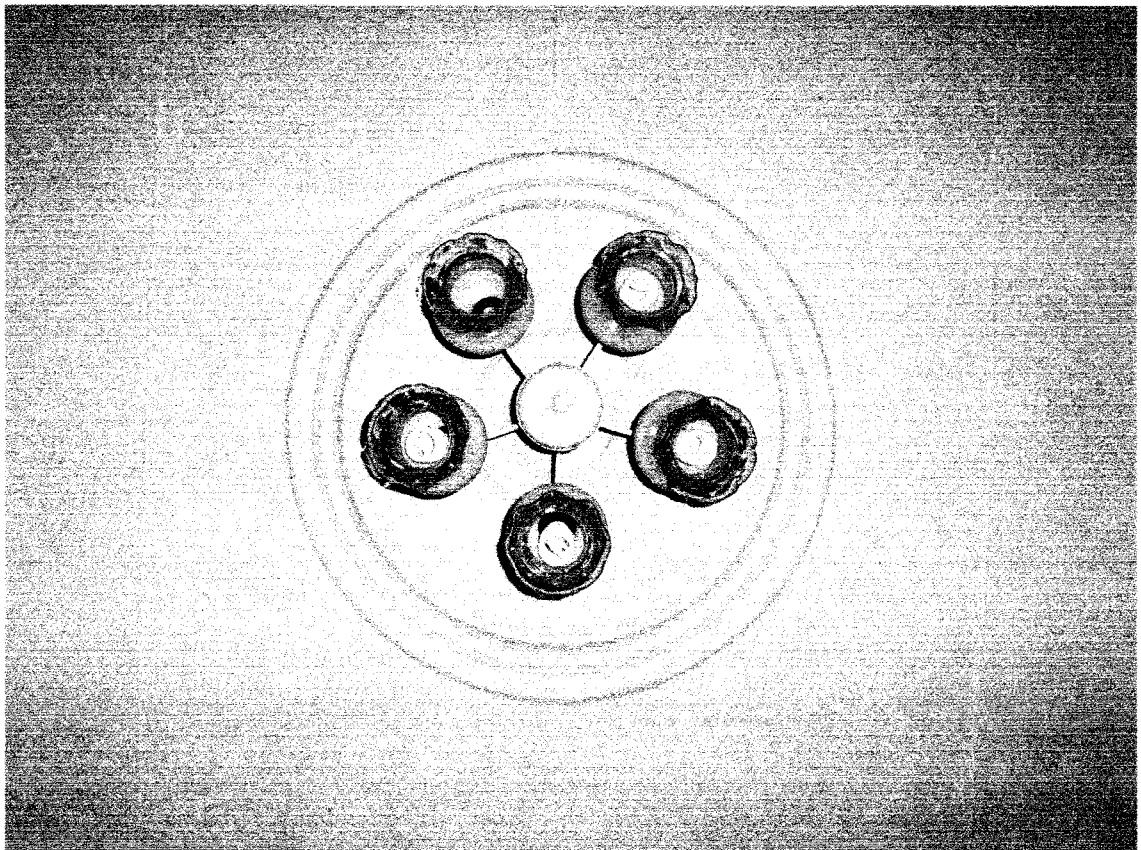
Второй этаж. Помещение 4. Потолочная розетка
